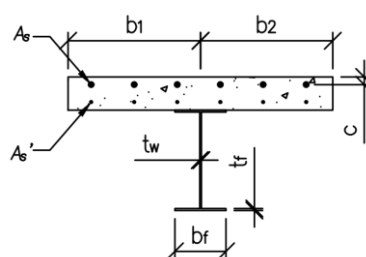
Dimensões da seção transversal da viga para estudo paramétrico.
